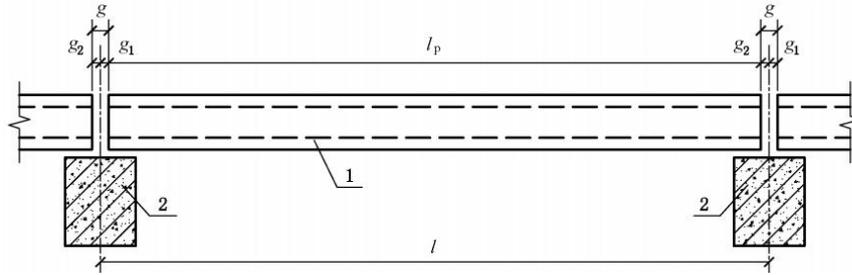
预应力混凝土空心板编号规则示意图
